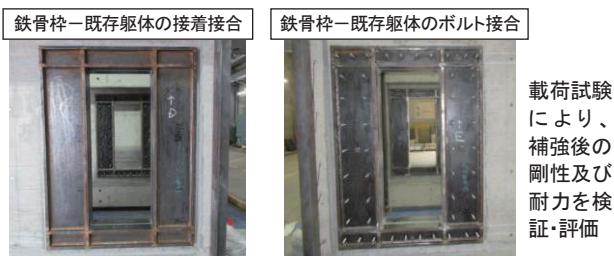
開口形成部分周囲の鉄骨枠補強の試験体
